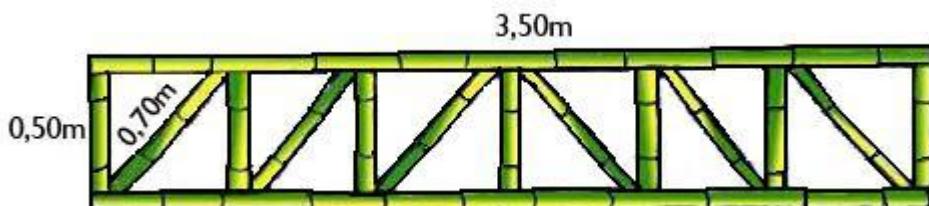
Dimensões utilizadas na viga treliçada Howe com perfil I
